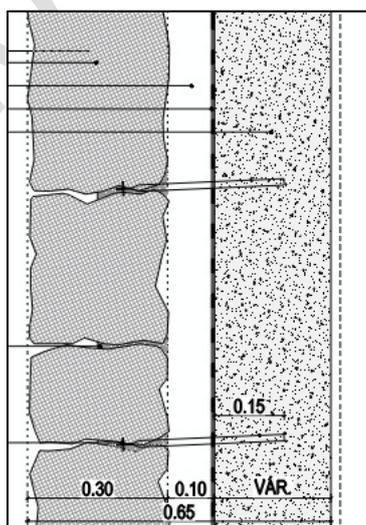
Pormenor de alvenaria em pedra rústica.
